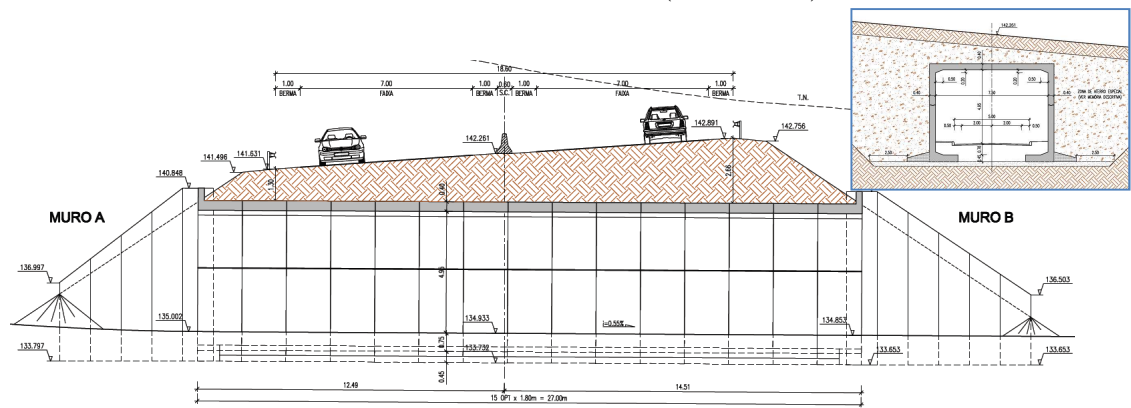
Corte longitudinal e transversal de uma Passagem Inferior, do tipo Box pré-fabricado. Fonte: Projeto Execução das OAC.
